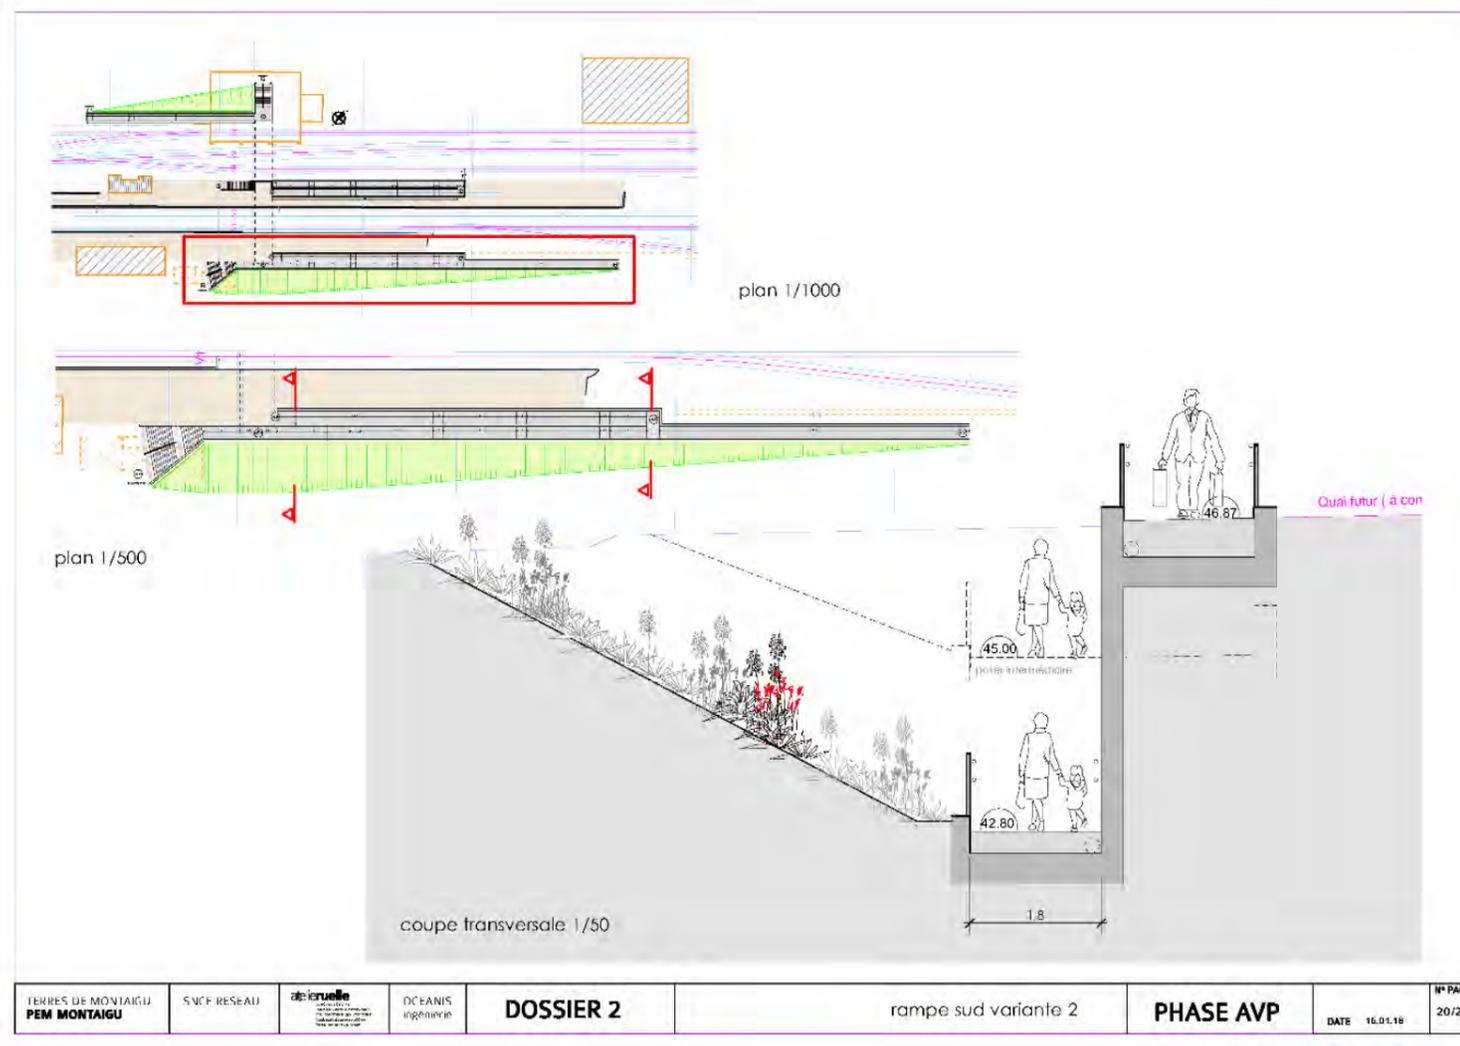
Vue en plan et en coupe de la rampe Sud d'accès au souterrain
